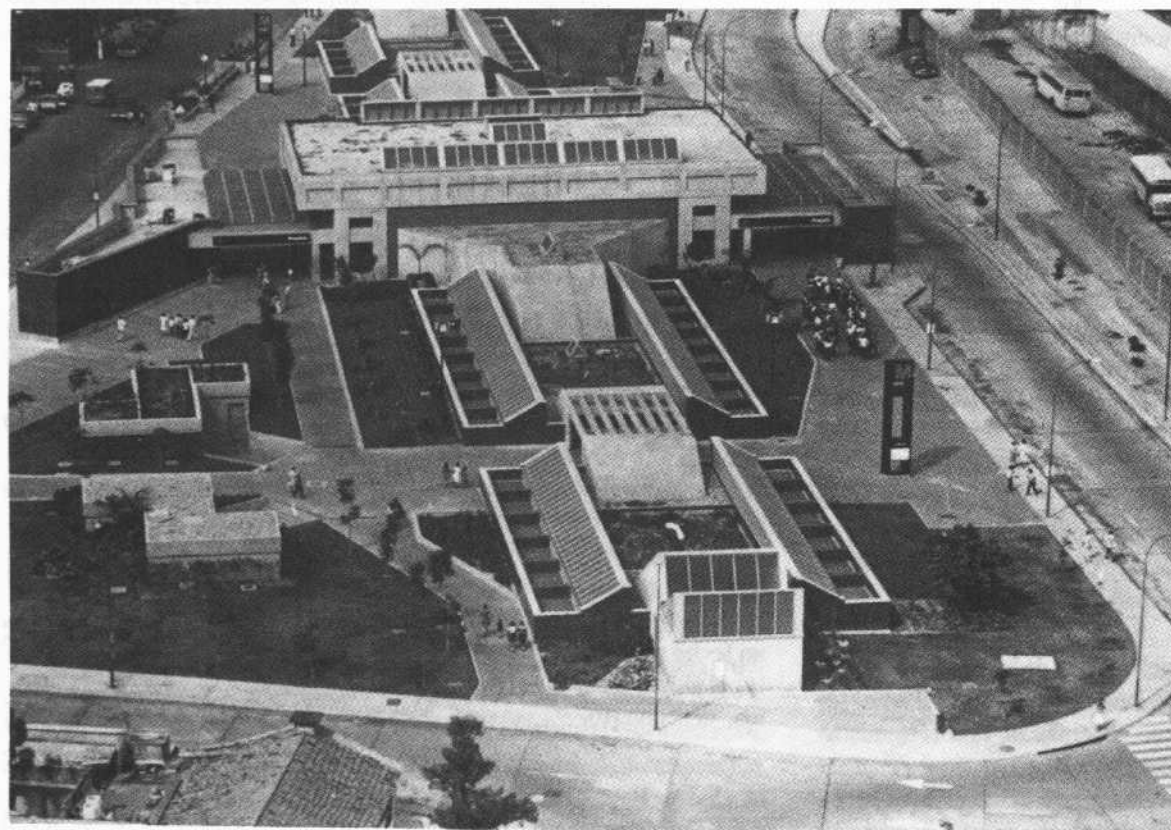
Vista sobre la plaza. Estación Propatria (1983).
